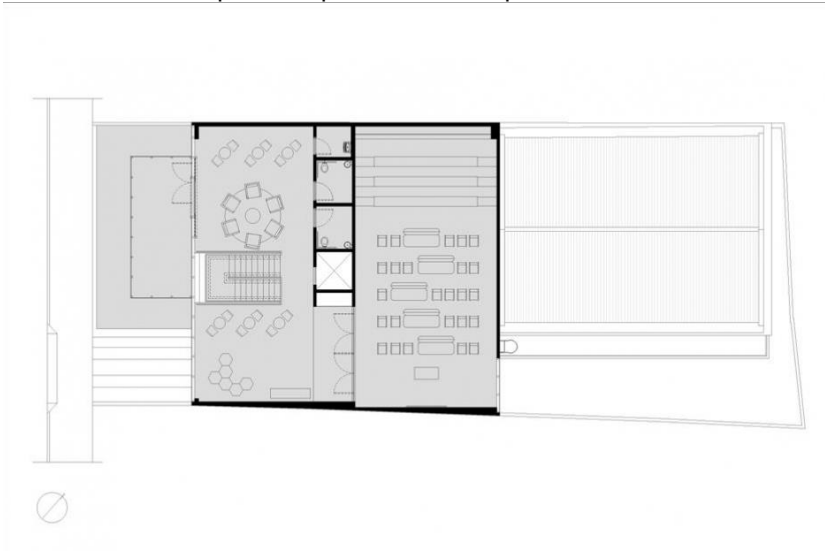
Jump Brasil, planta baixa 1º pavimento.
